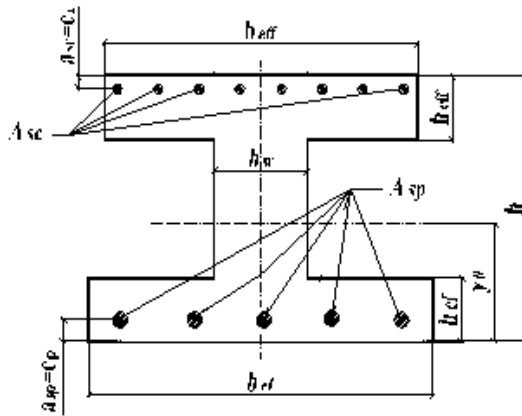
Схема розташування арматури в перерізі плити
